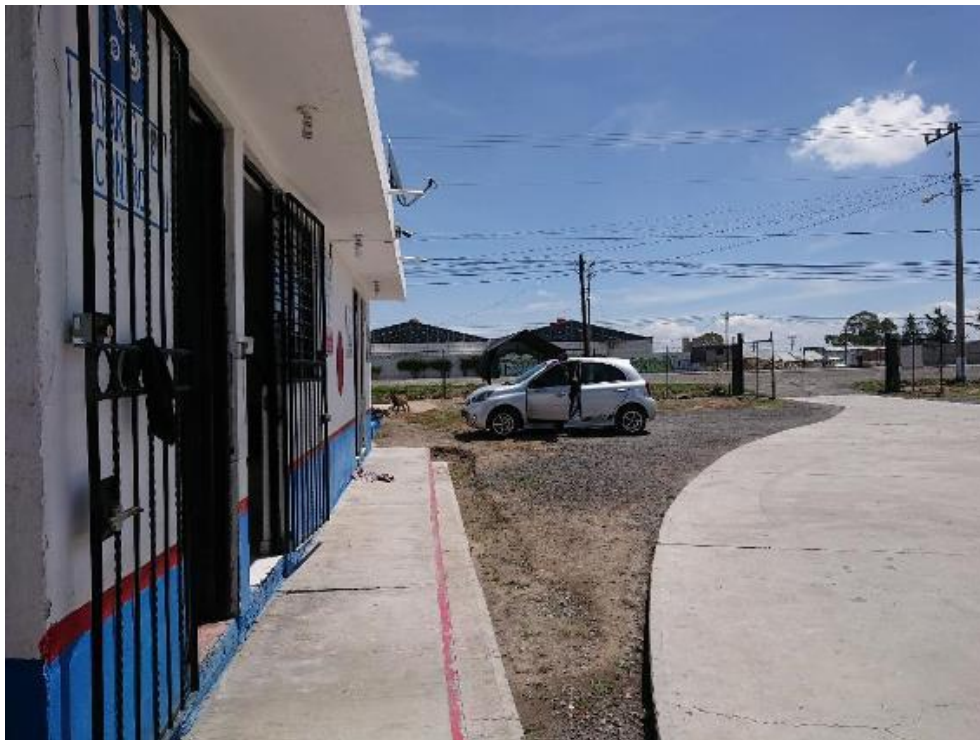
Vista lateral donde se observa, el edificio existente y pavimentación del suelo previa en partes de la estación
